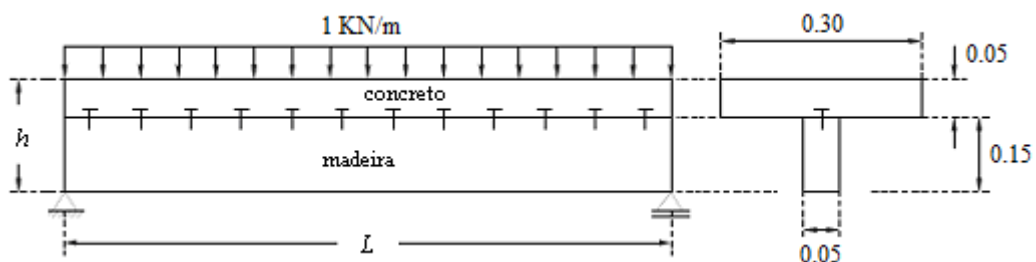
Viga mista concreto-madeira bi-apoiada (dimensões em m)
